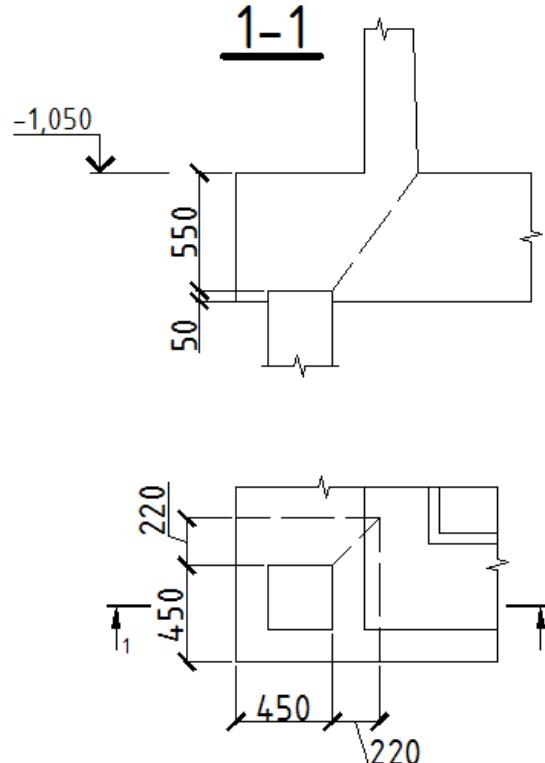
Схема работы ростверка на продавливание угловой сваей
